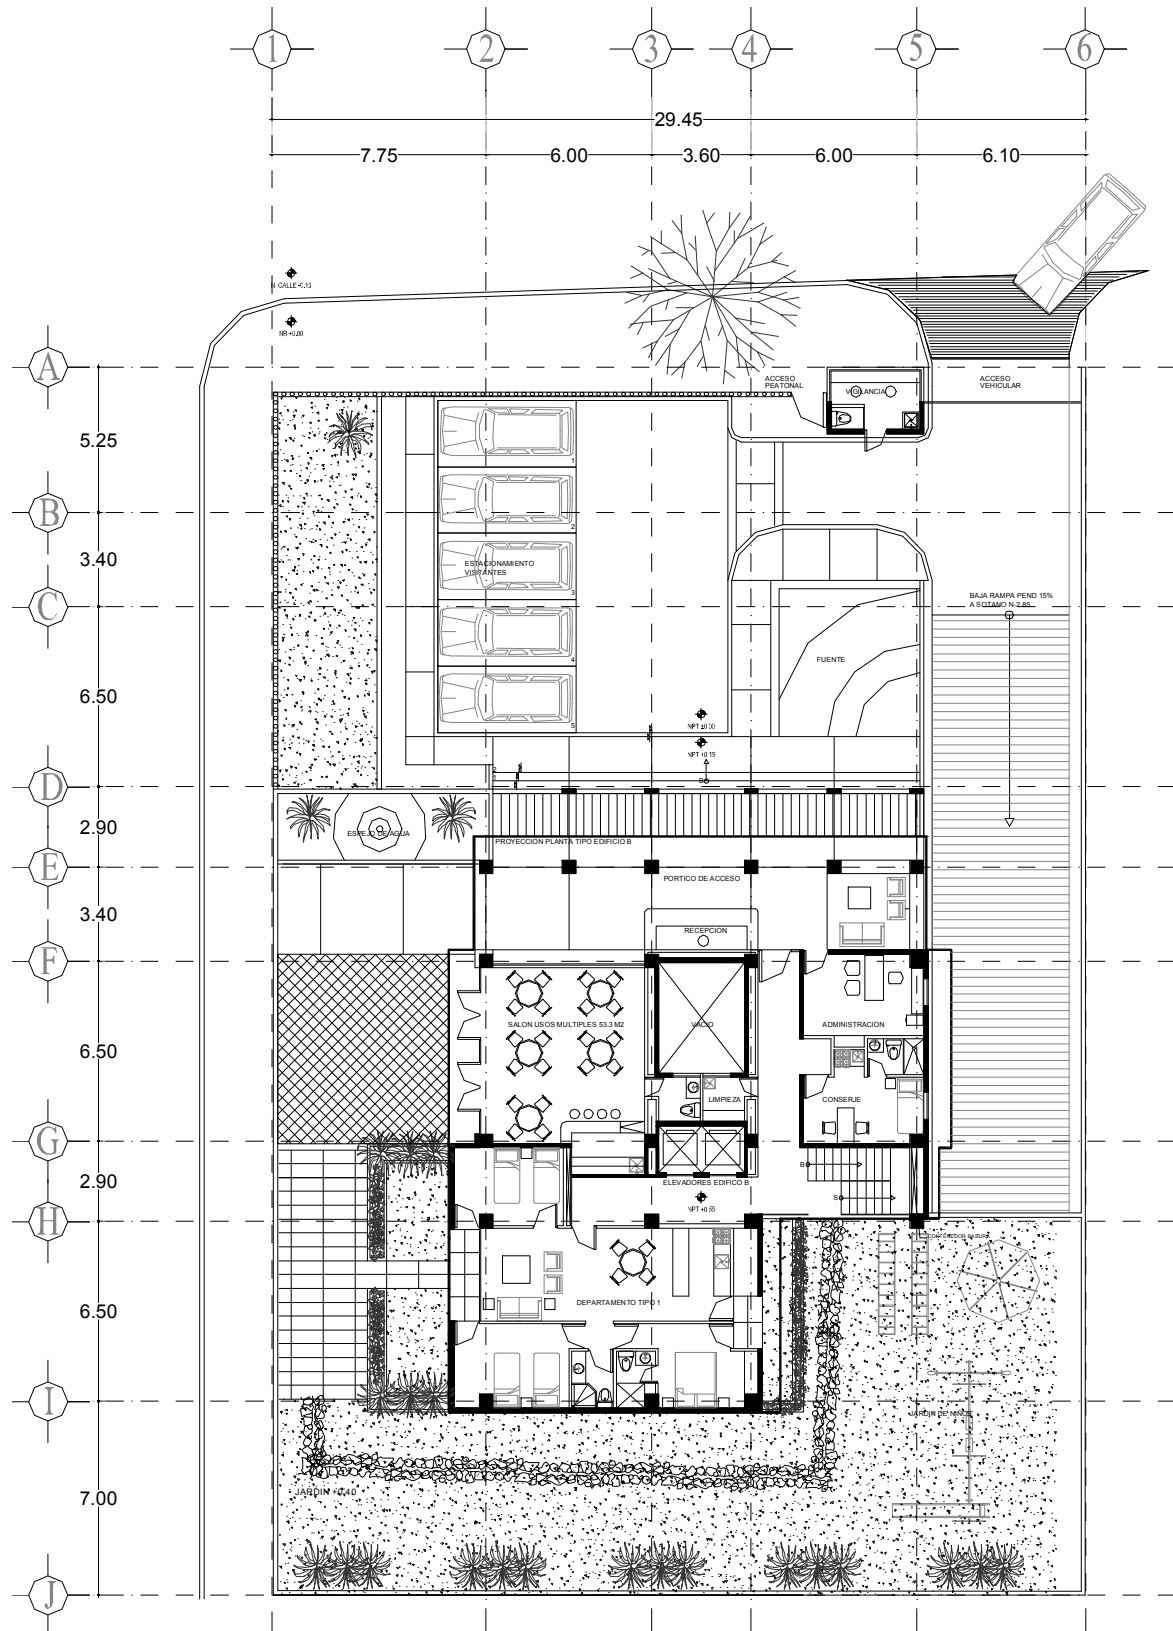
PLANTA ARQUITECTÓNICA COMPLETA DEL EDIFICIO
